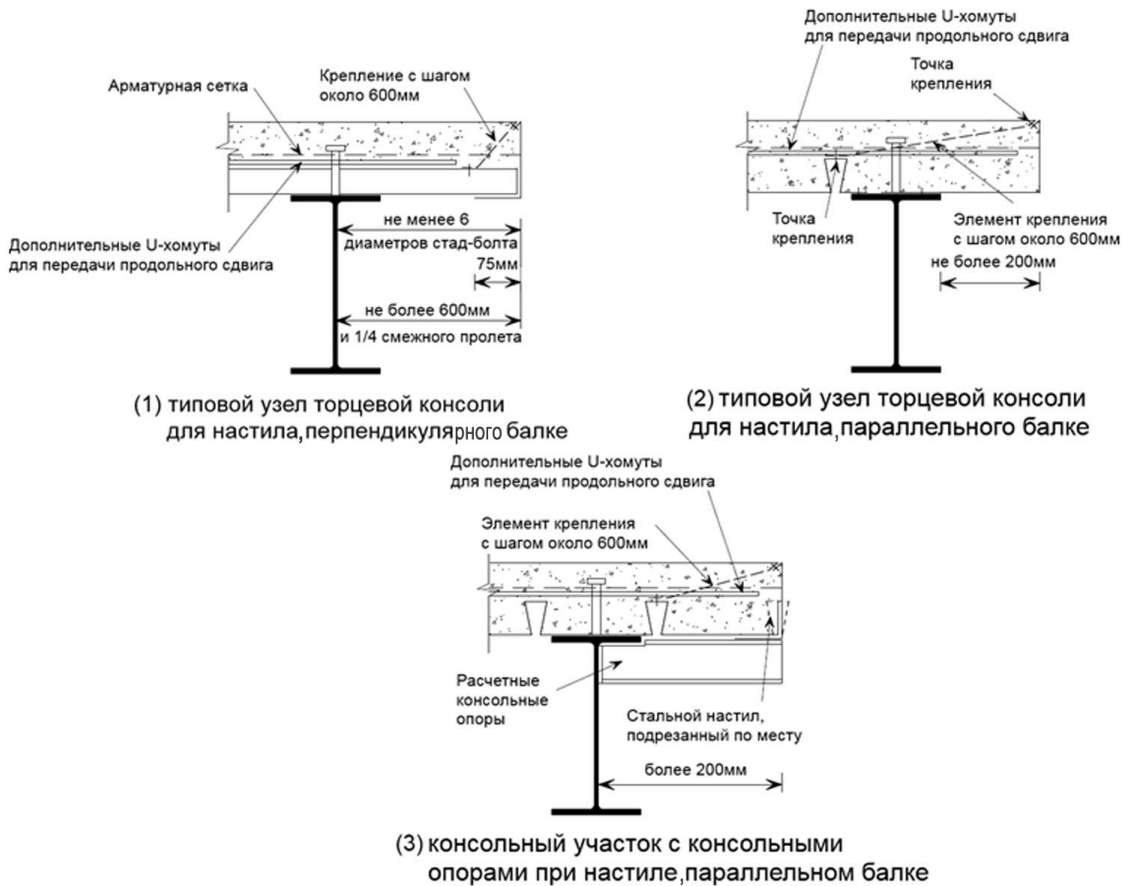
Типовые узлы торцов сталежелезобетонных плит
